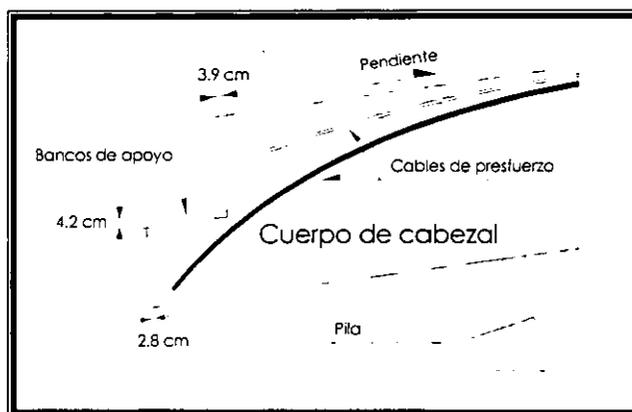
Trayectoria de cables de presfuerzo longitudinalmente.
